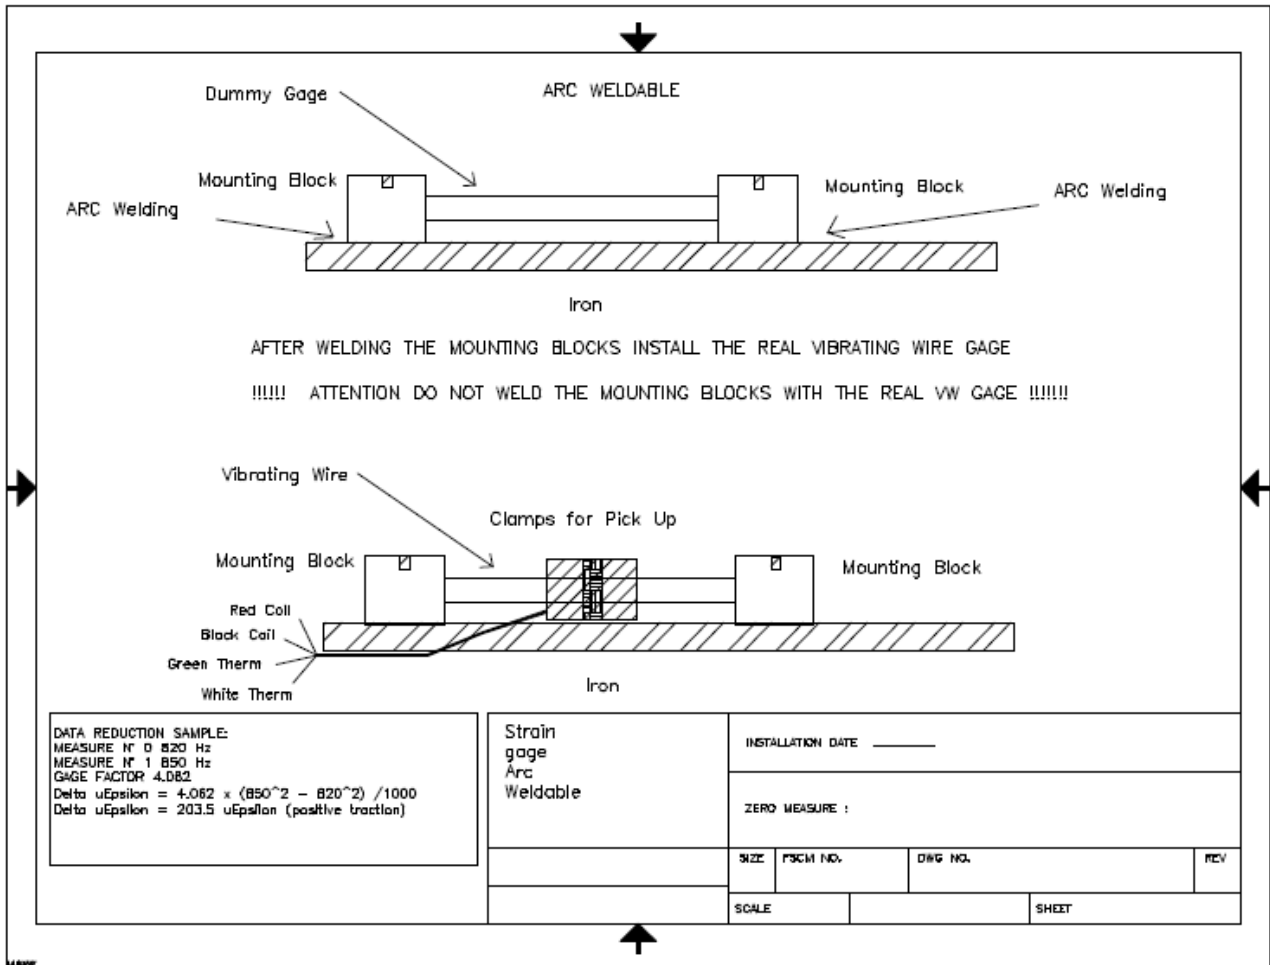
Estensimetro da saldare (Weldable type) – Schema installazione
